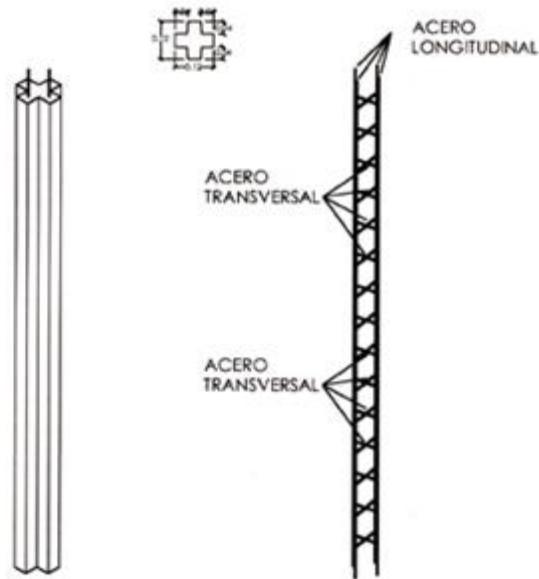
Detalle de Columna (Machón). Fuente Ing. Iván Rodríguez (2015)
